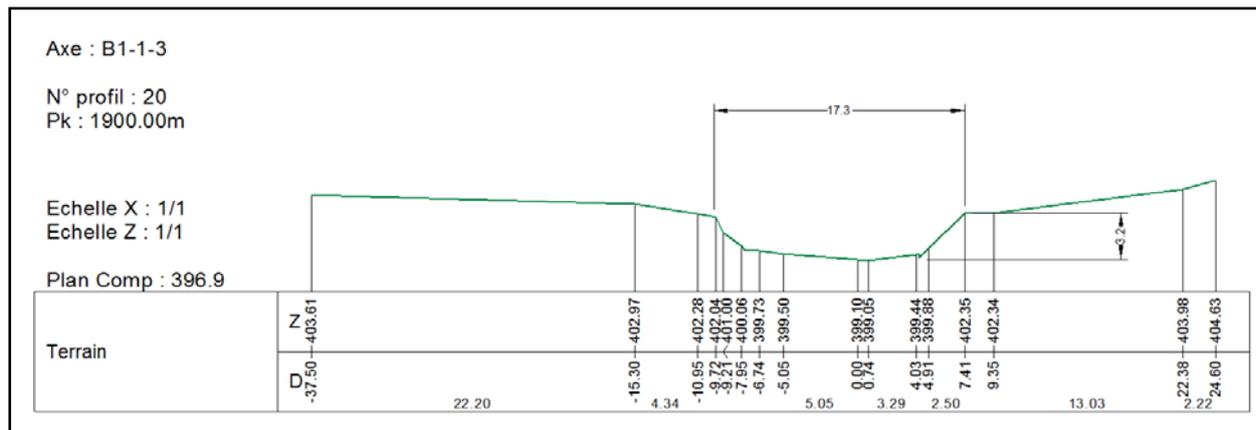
Profil en travers 2 du Guiers Mort à St-Laurent du Pont.
